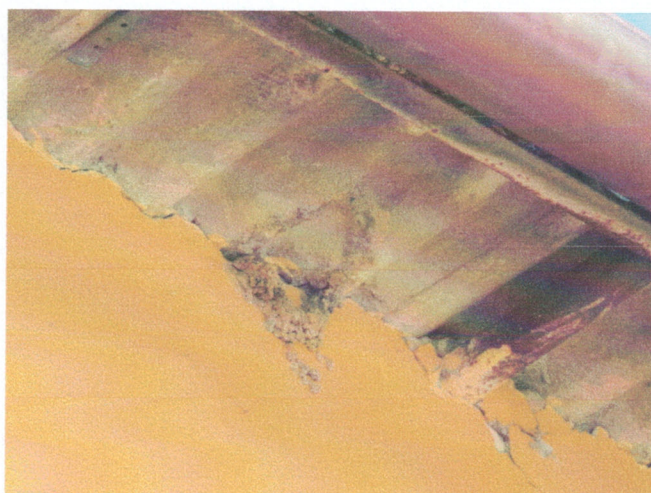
Miejsca lęgowe oknówek na elewacji zachodniej.
